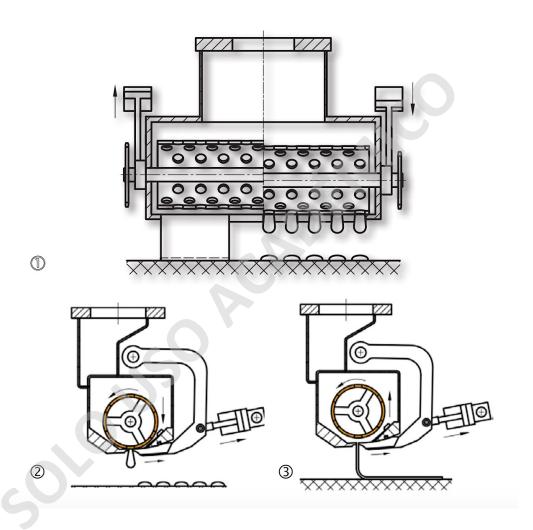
Ilustración Máquina para Demarcación Termoplástica Multipunto Fuente: Hoffman – Road Marking Systems
